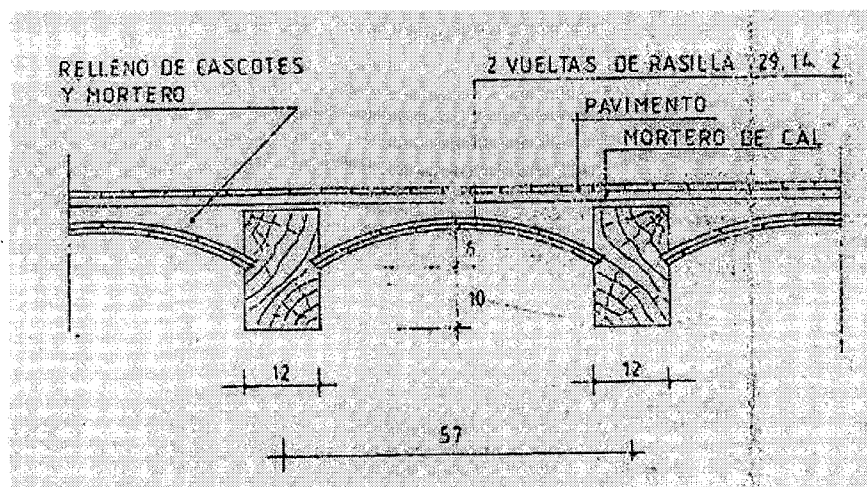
Detalle del forjado de vigueta madera y bovedilla cerámica tomado de los planos arquitectónicos originales.
